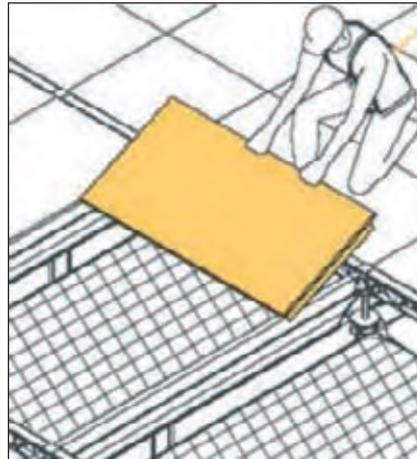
Esquema de colocación de encofrado horizontal para forjado con red bajo el mismo
